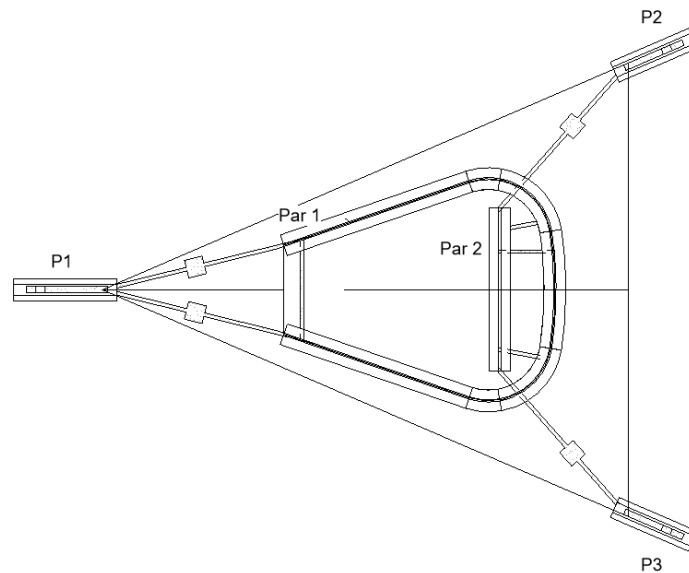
Nomenclatura dos elementos estruturais vistos na planta baixa do térreo. Fonte: Autor.
